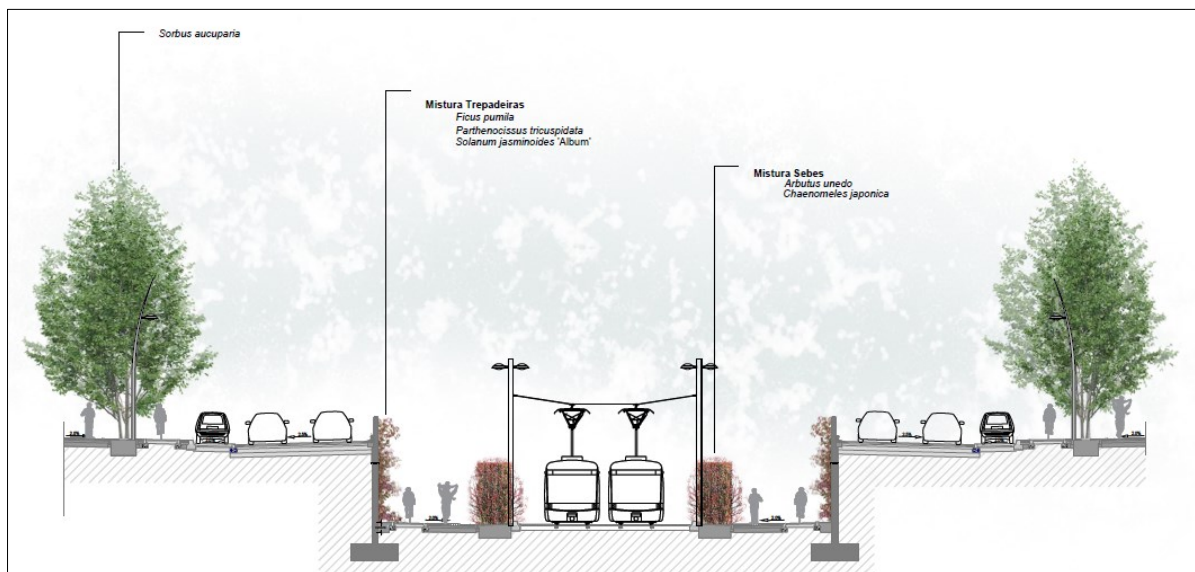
Troço Candal-Rotunda: perfil tipo.
